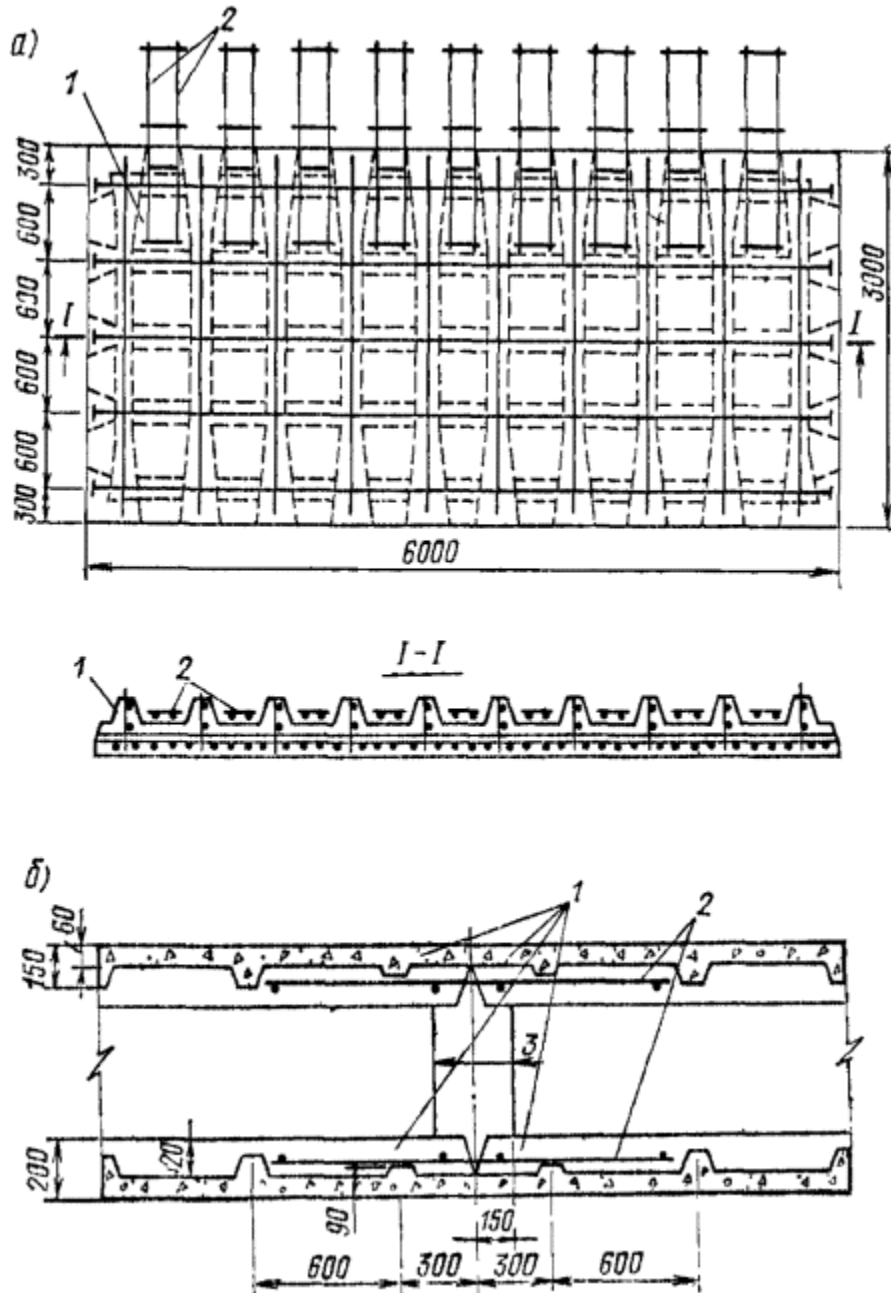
Армирование ребристой армопанели с применением бессварного способа стыкования
